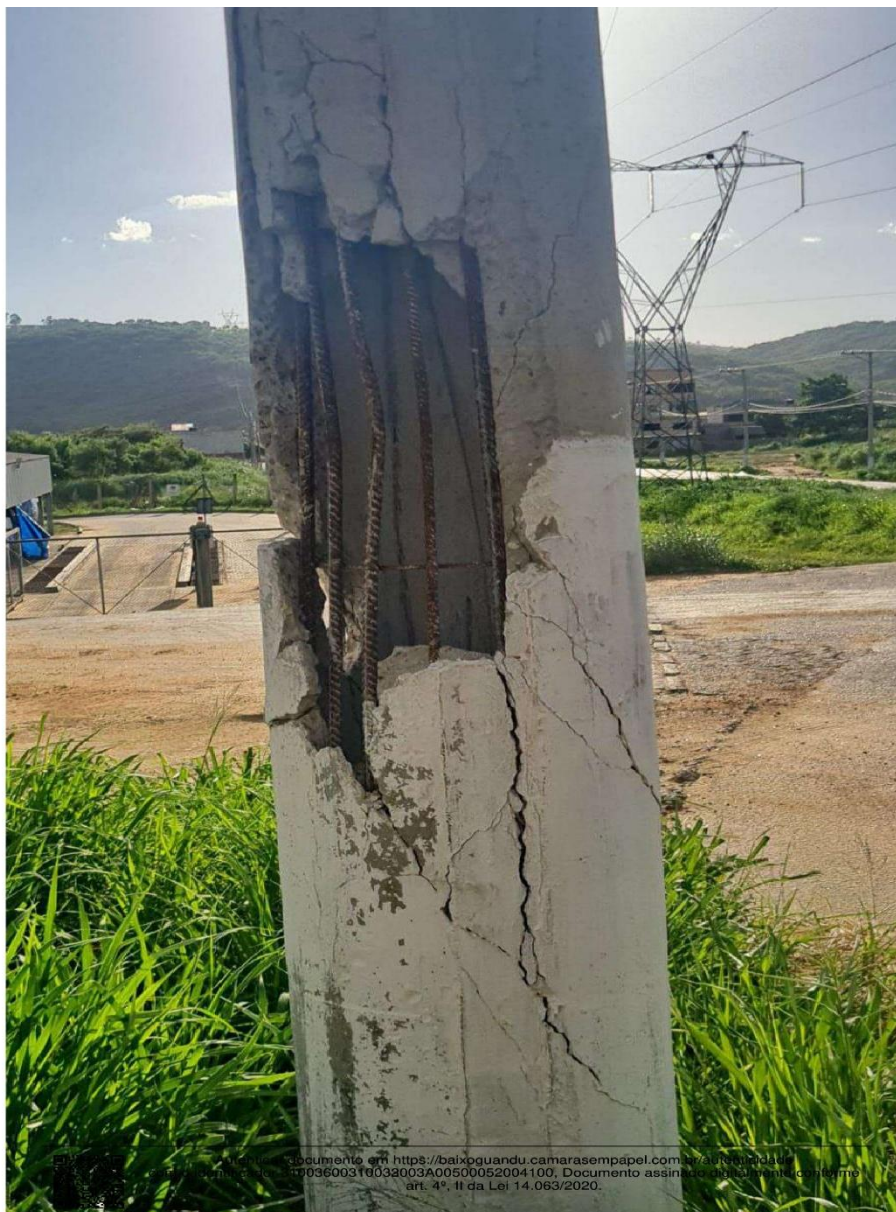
Poste de concreto com ruptura estrutural e exposição de armadura metálica.
